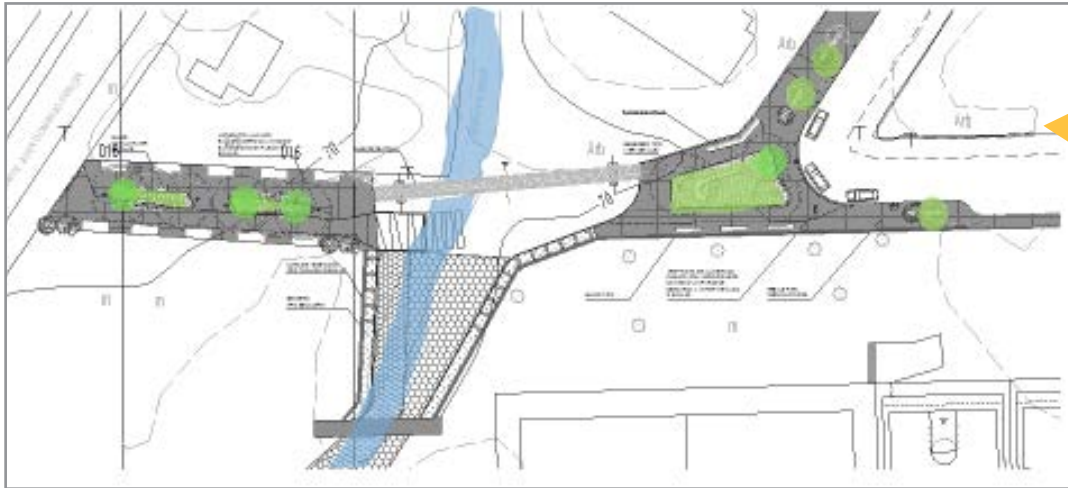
Detalle de zona cruce peatonal, calle Felicidad.
